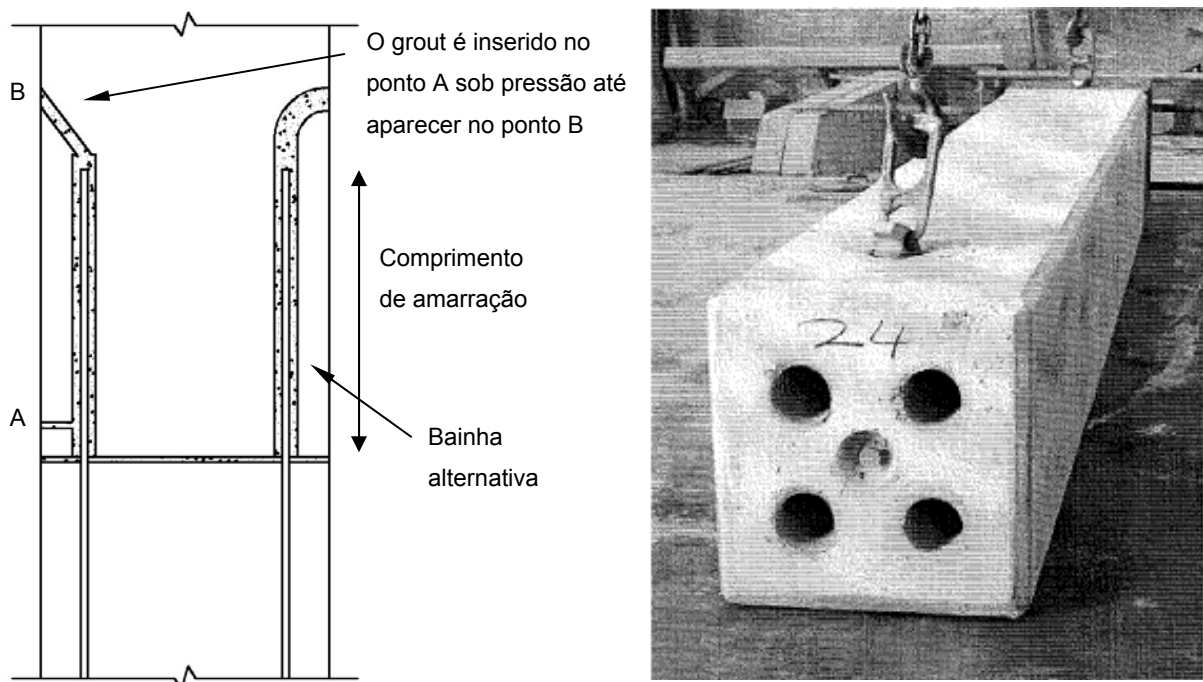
Ligação pilar – pilar com recurso a bainhas preenchidas com grout (adaptado de [26])
